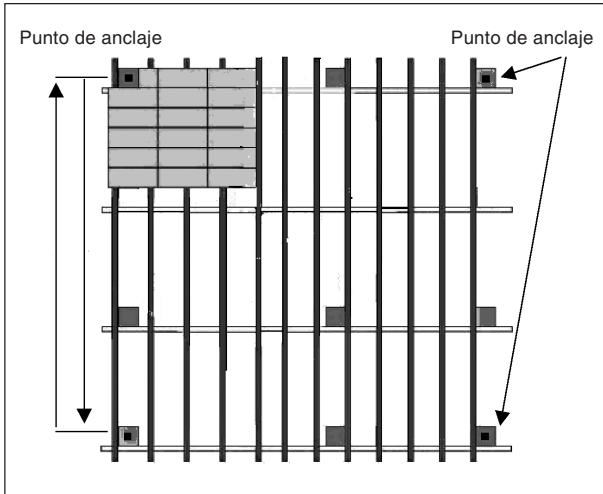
Pilares de montaje de los anclajes del sistema anticaídas con mástiles
